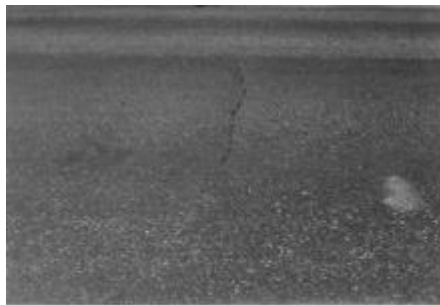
Grietas longitudinales y transversales - severidad baja
